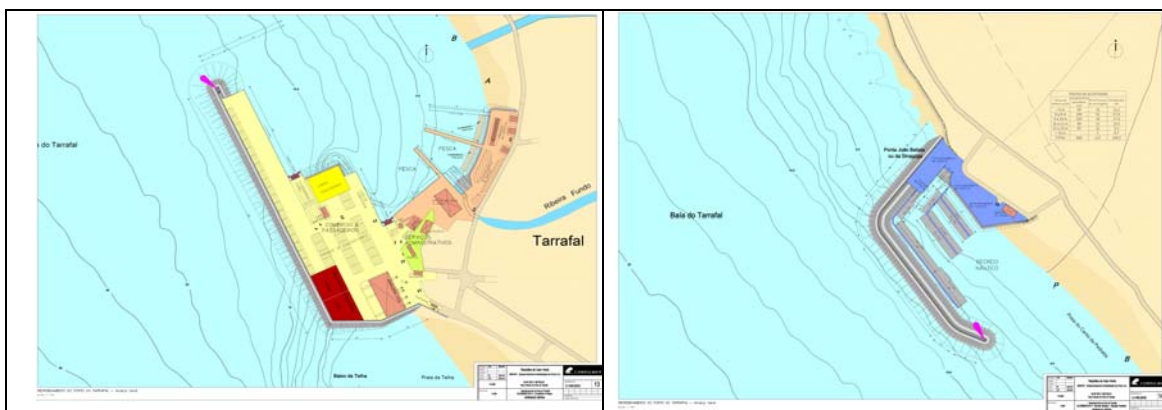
Porto do Tarragal – Planta Geral da Solução Alternativa 4A
